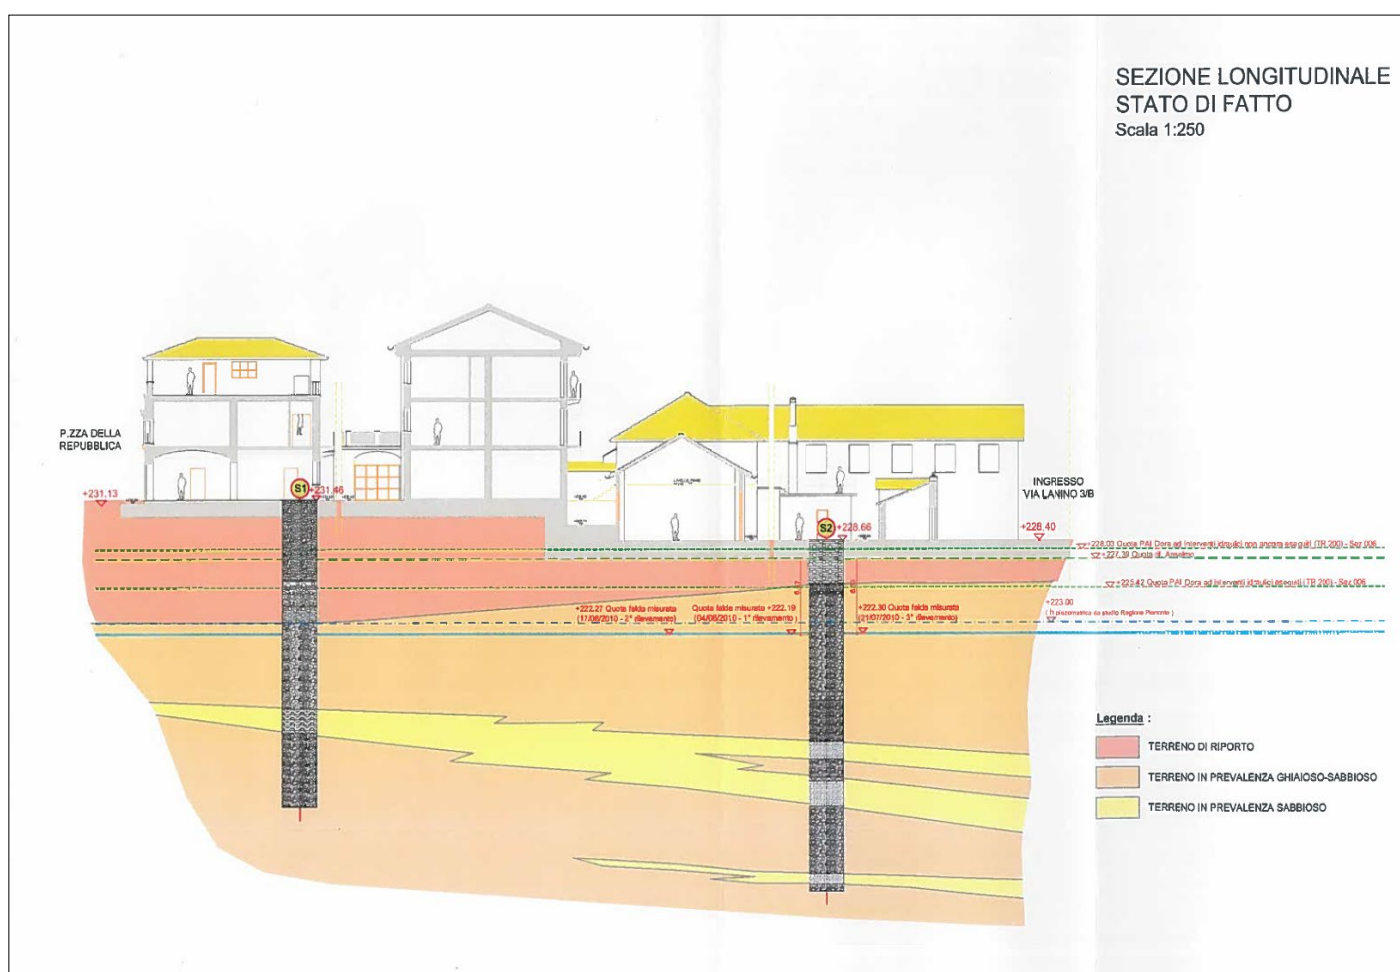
SEZIONE LONGITUDINALE STATO DI FATTO
